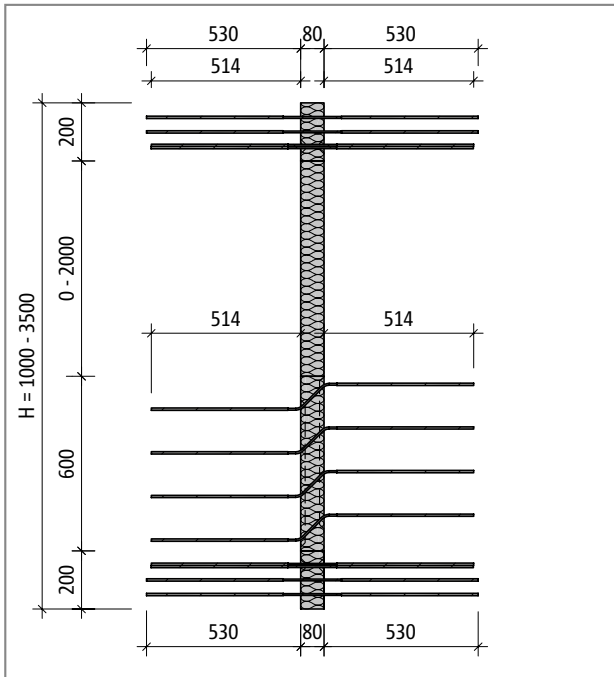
Schöck Isokorb® tipo W10S, sezione del prodotto
